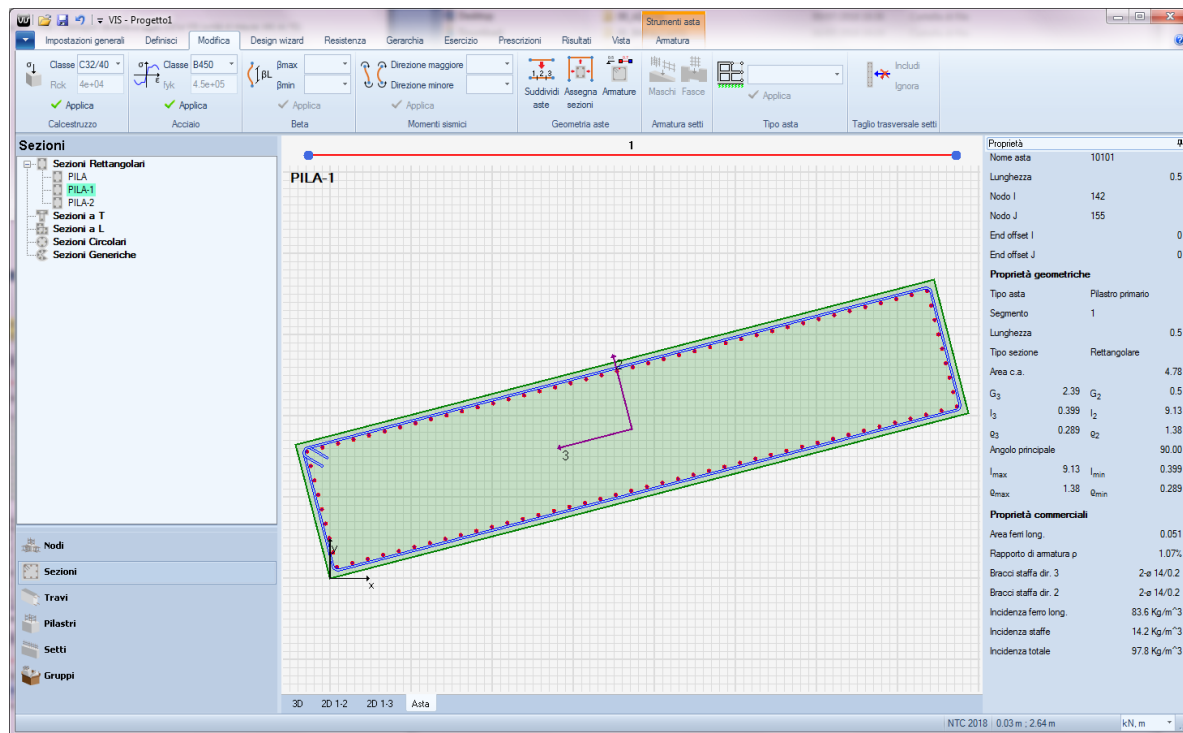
Pila 1: sezione di verifica 7.285 x 1.00 – ϕ 26/10
